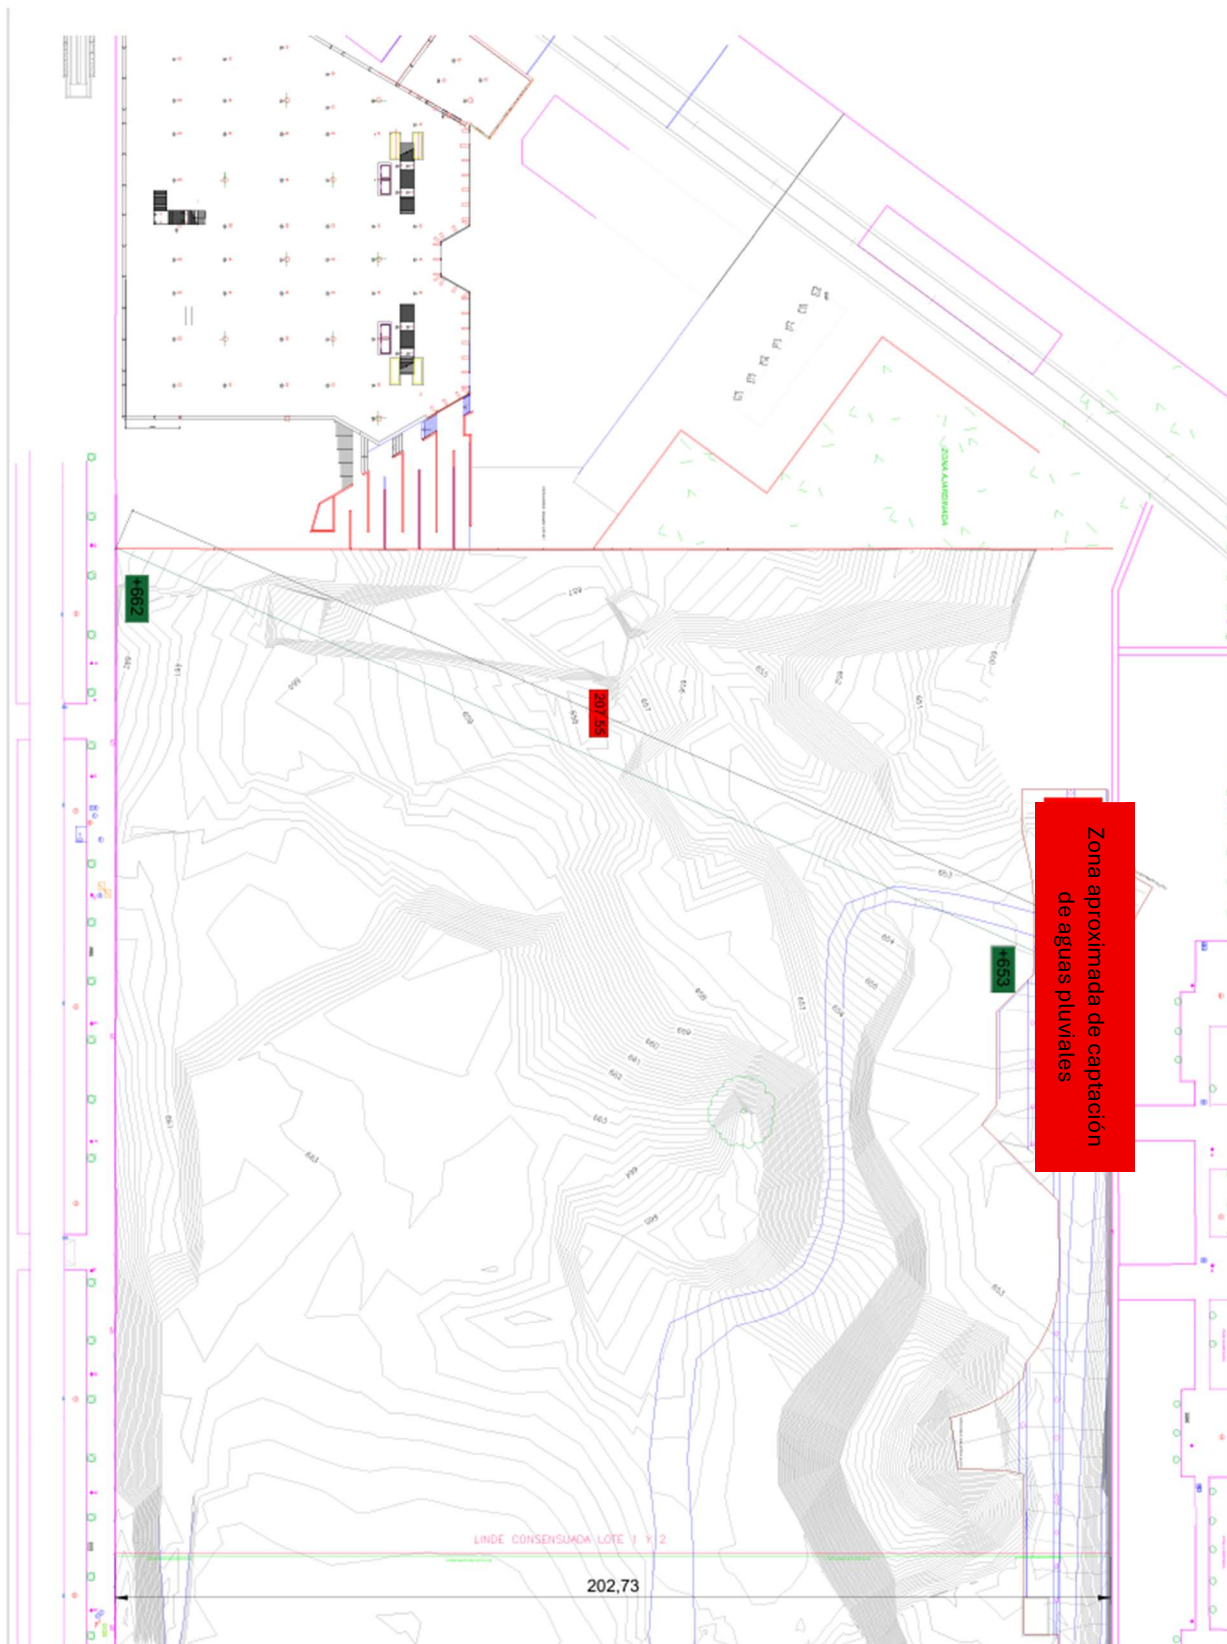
Plano acotado para el cálculo del tiempo de concentración. Fuente: elaboración propia
